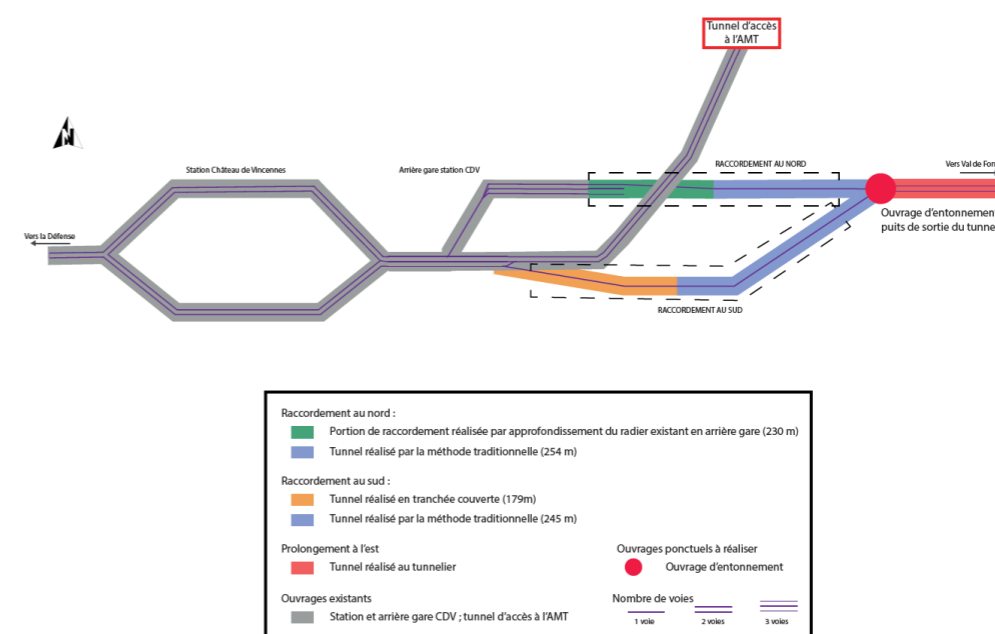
Méthodes constructives du raccordement au tunnel de la ligne existante (Sources : Ingérop sur la base de données RATP)
